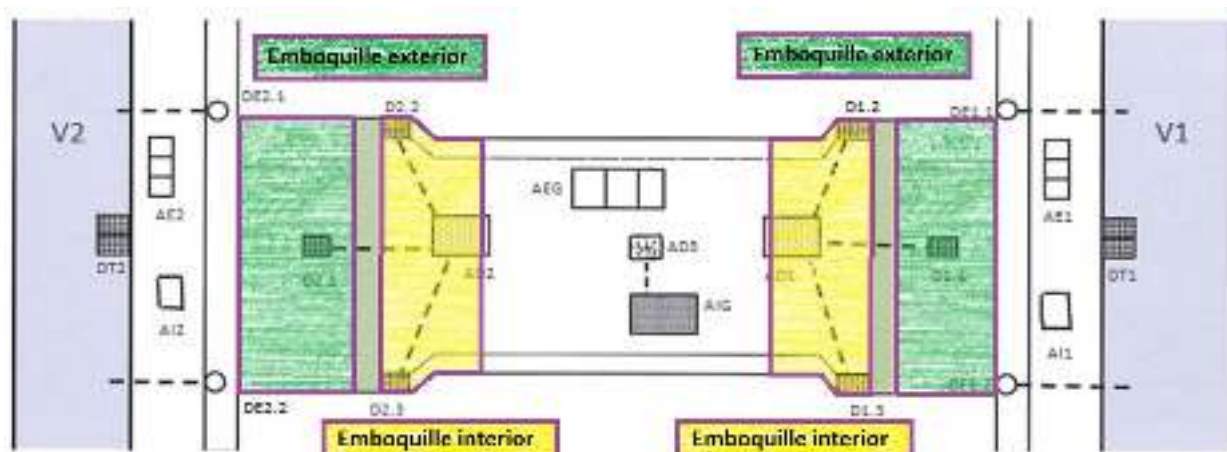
Esquema general en planta de las zonas interior y exterior de emboquilles
